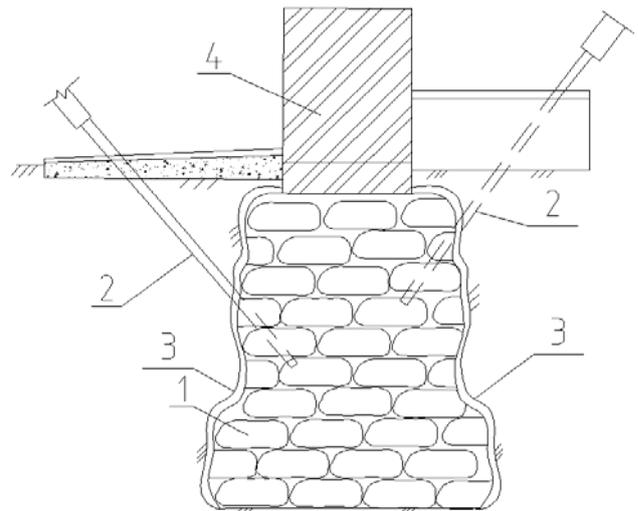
Закрепление бутовой (кирпичной) кладки фундамента цементацией и силикатно-полизианитным раствором: 1 – усиливаемый фундамент; 2 – иньекторы для нагнетания жидкого цементного раствора; 3 – наплывы раствора; 4 – кирпичная стена
